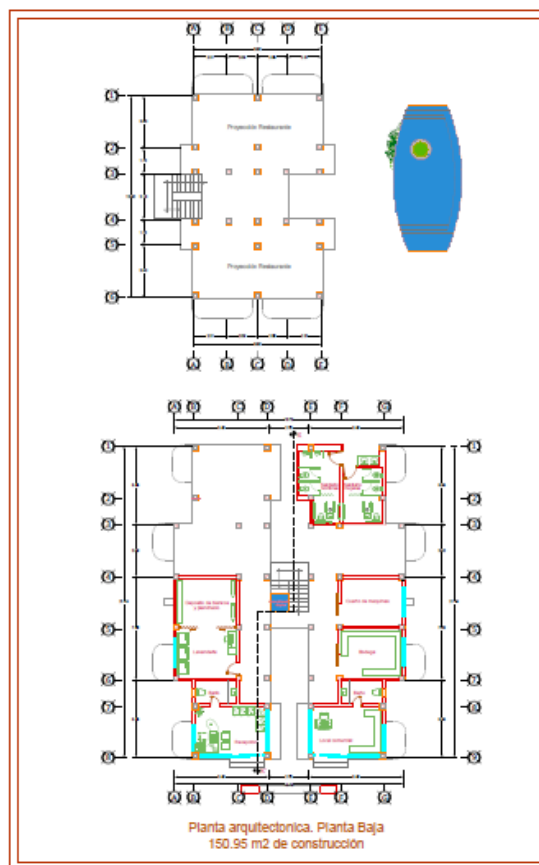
Distribución del sembrado del proyecto en el planta baja.
